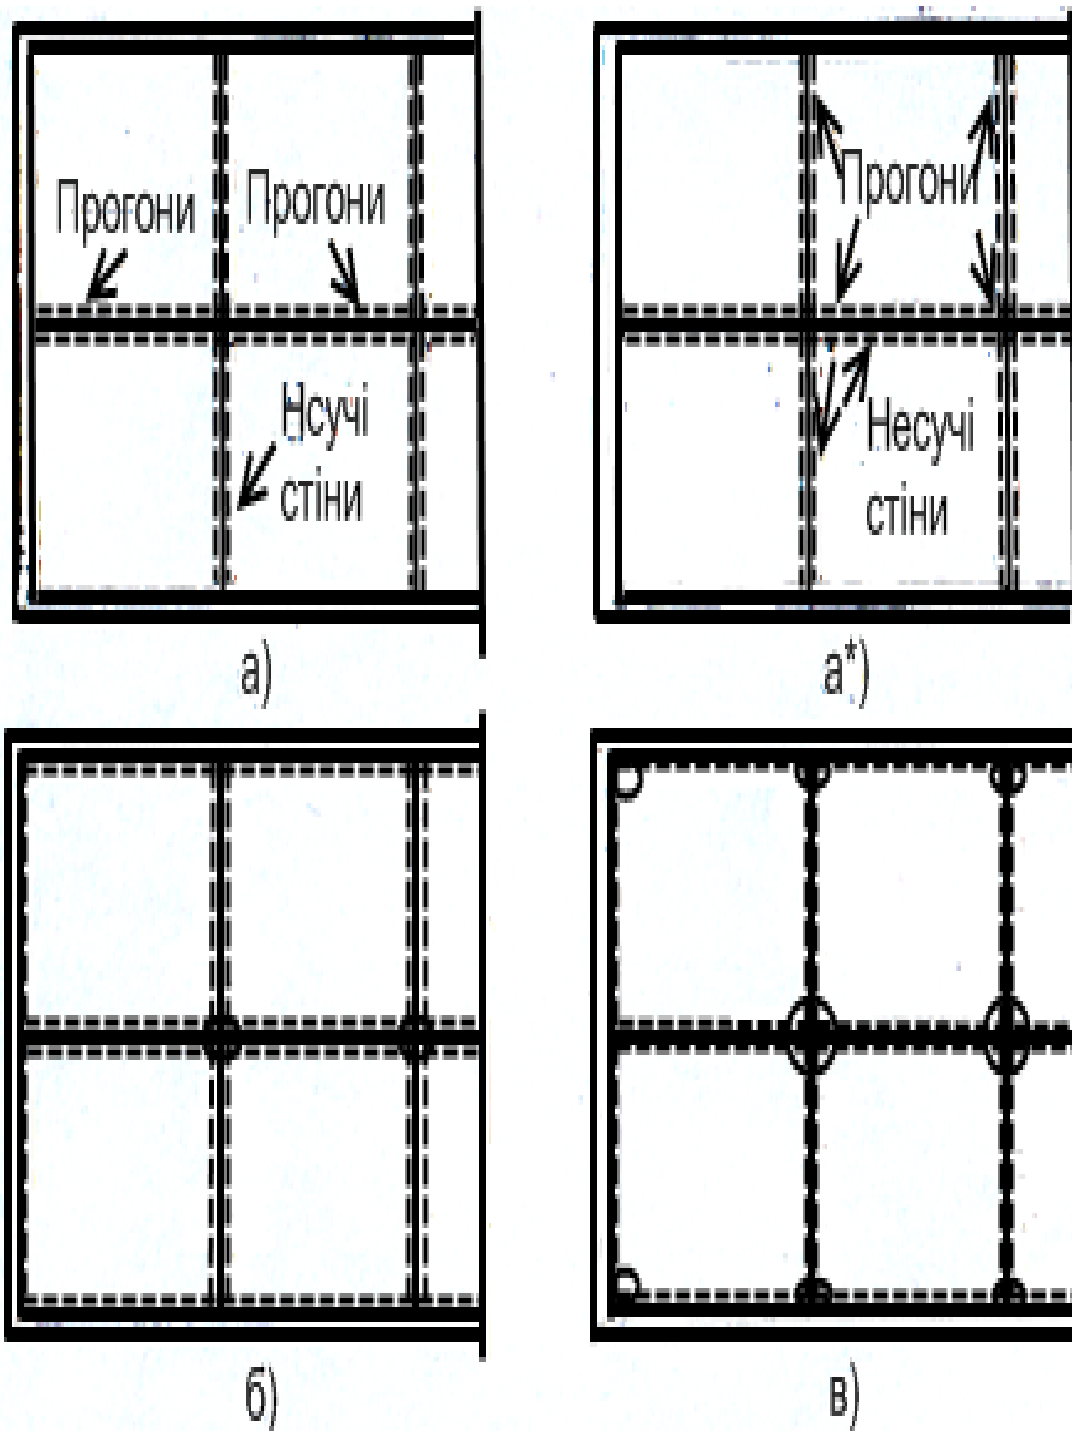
Схема з повздовжніми і поперечними несучими конструкціями
